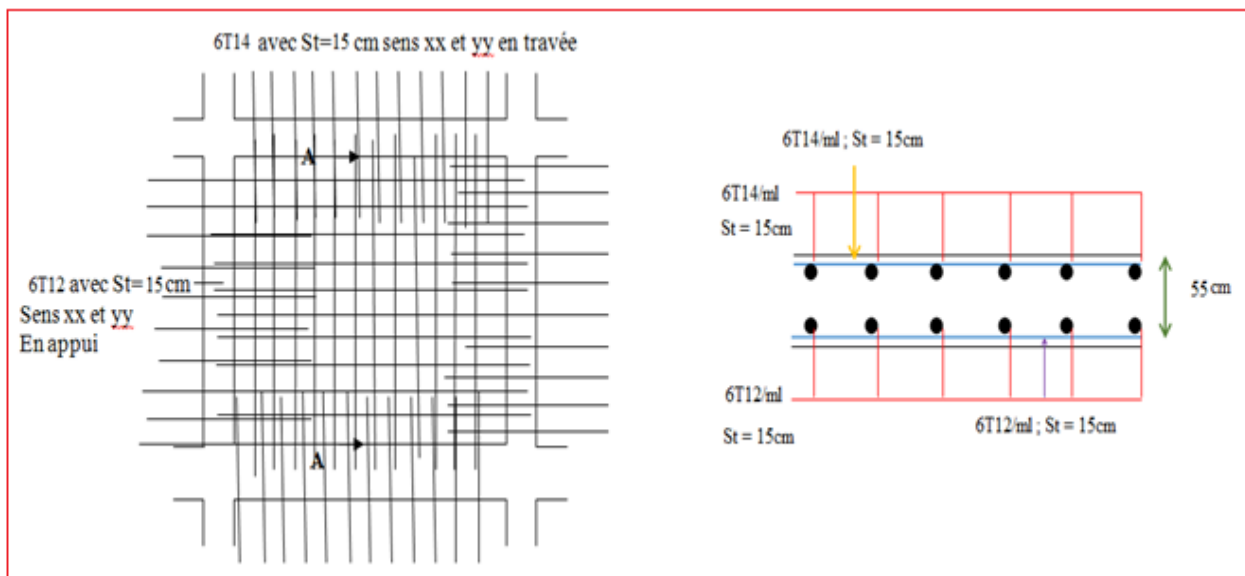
Ferrailage de la dalle du radier pour une bande de 1m sens x-x et y-y
